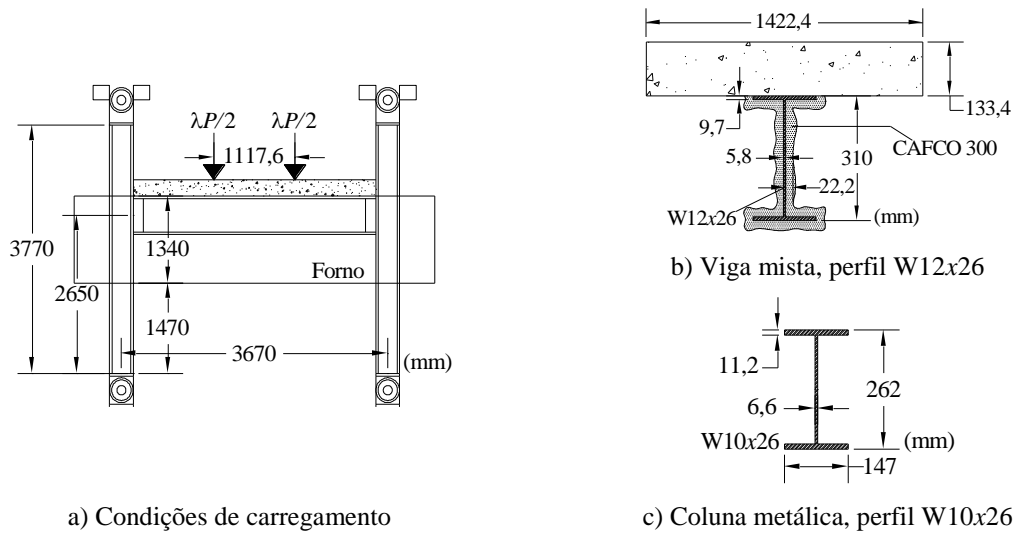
Características gerais do sistema estrutural (dimensões em mm)
